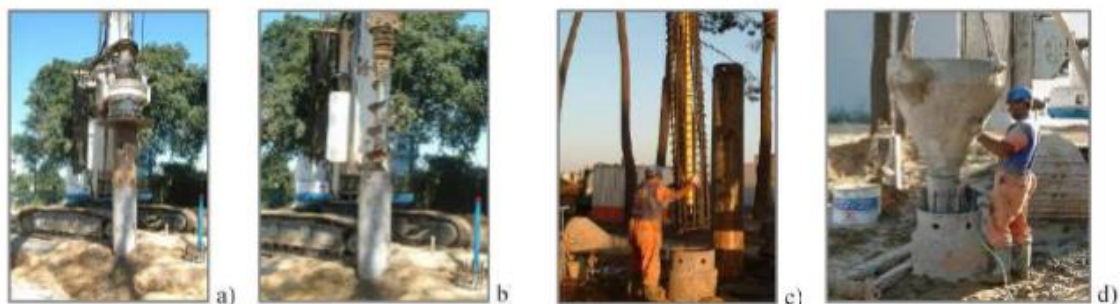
Execução de estaca moldada com tubo moldador. (Siva, 2015)
